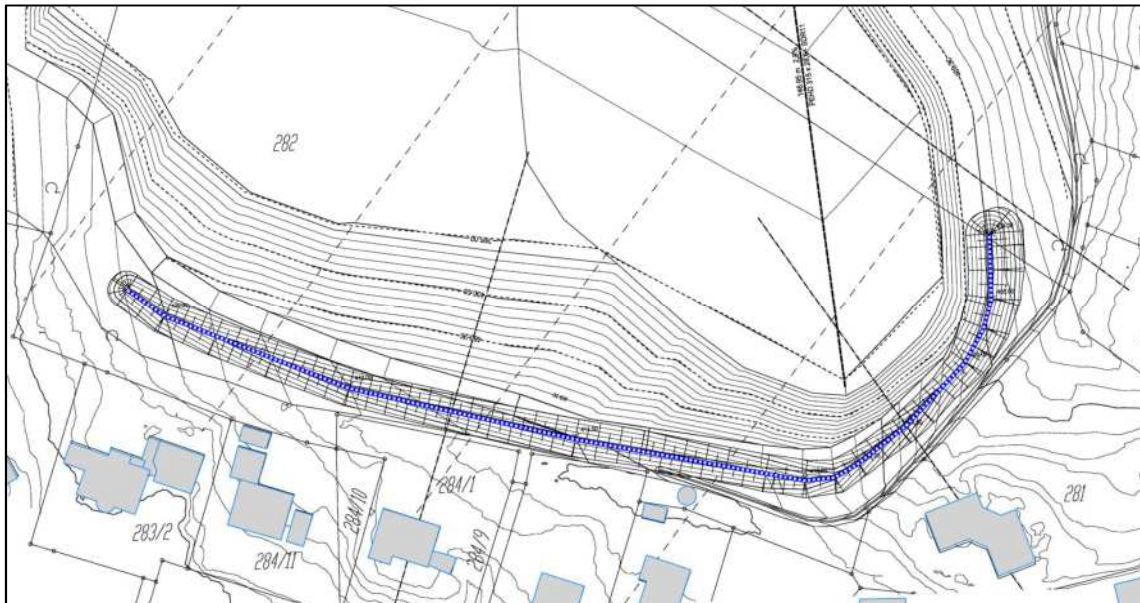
Lageplan mit Darstellung des Lärmschutzwalls für Ebene 1
